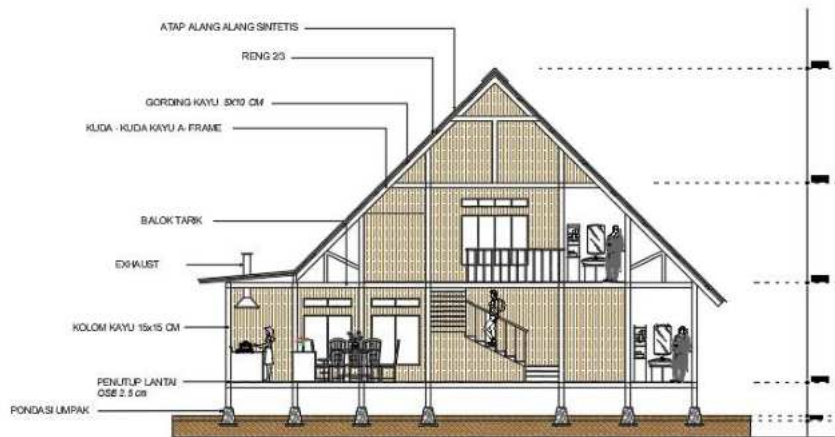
22 Konsep Struktur Dan Konstruksi Pada Bangunan Villa Tipe 1
